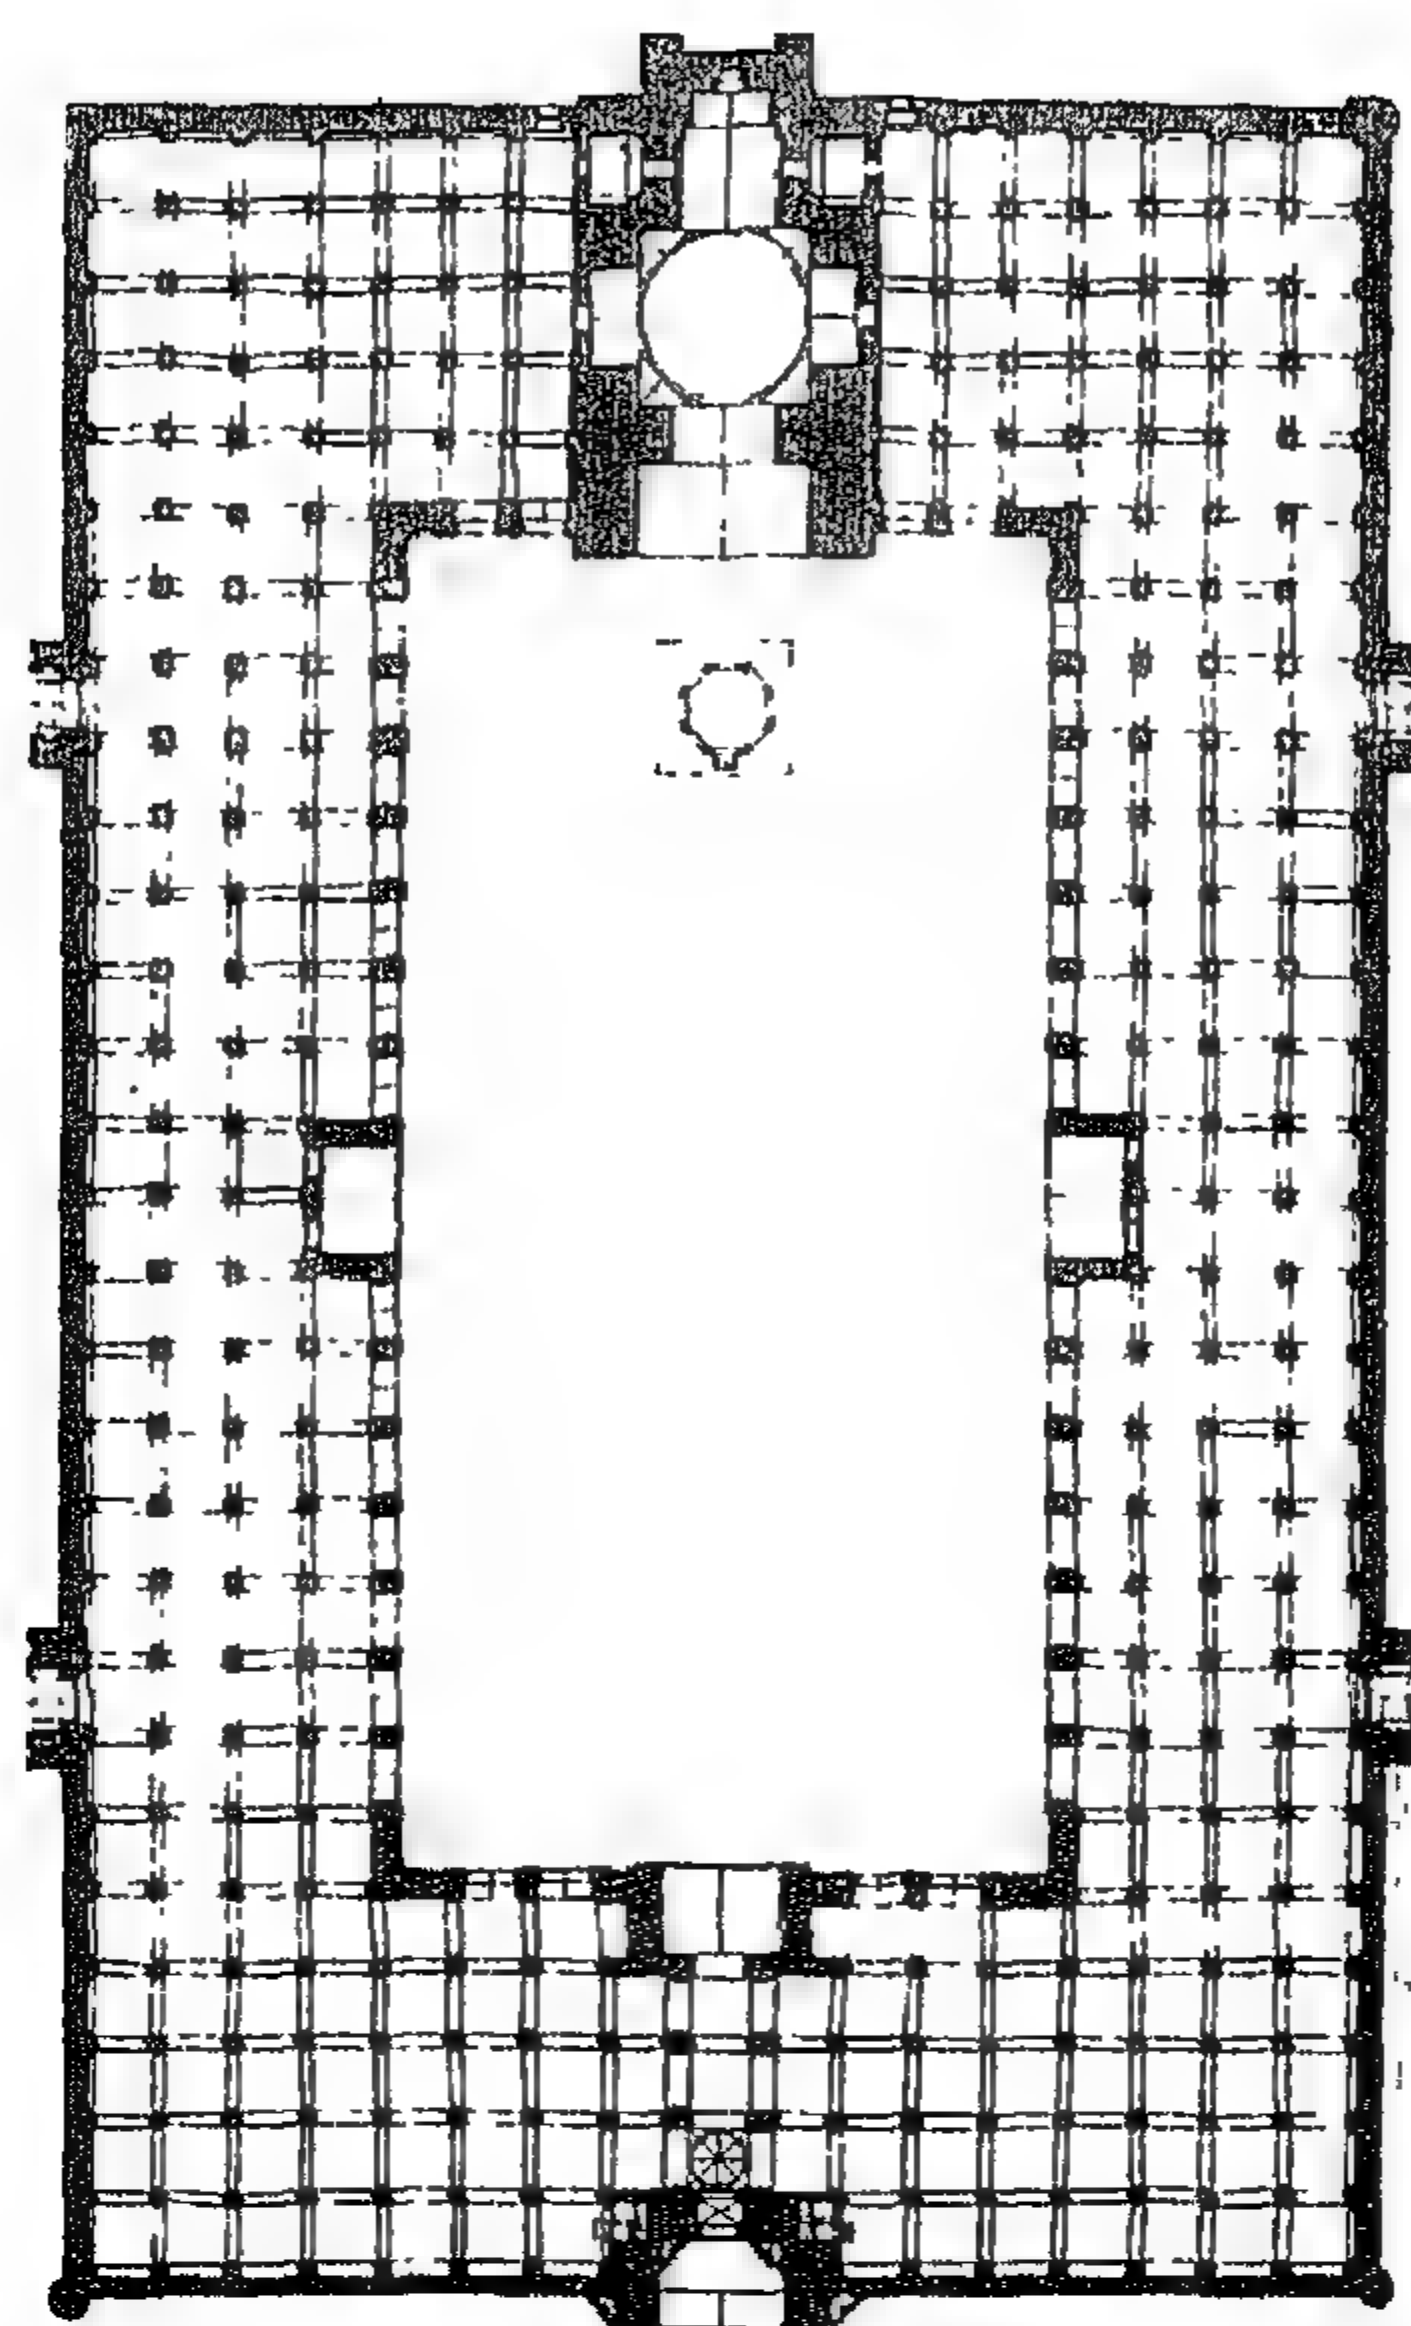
مسقط أفقي لمسجد بيبي خانم في سمرقند .
